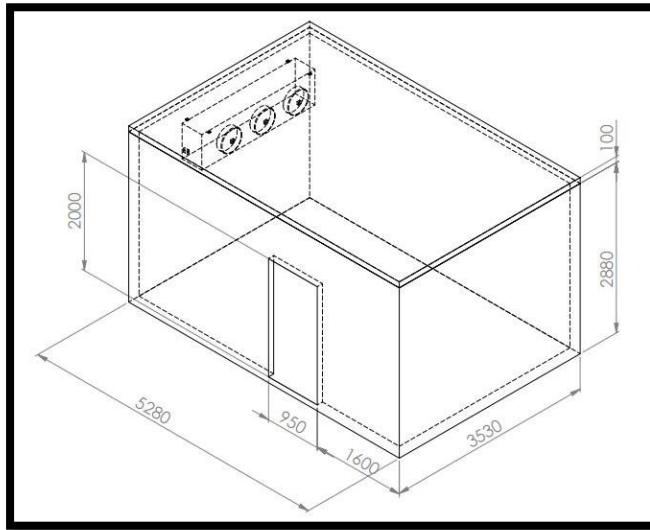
Vista isométrica de la cámara de la planta piloto
